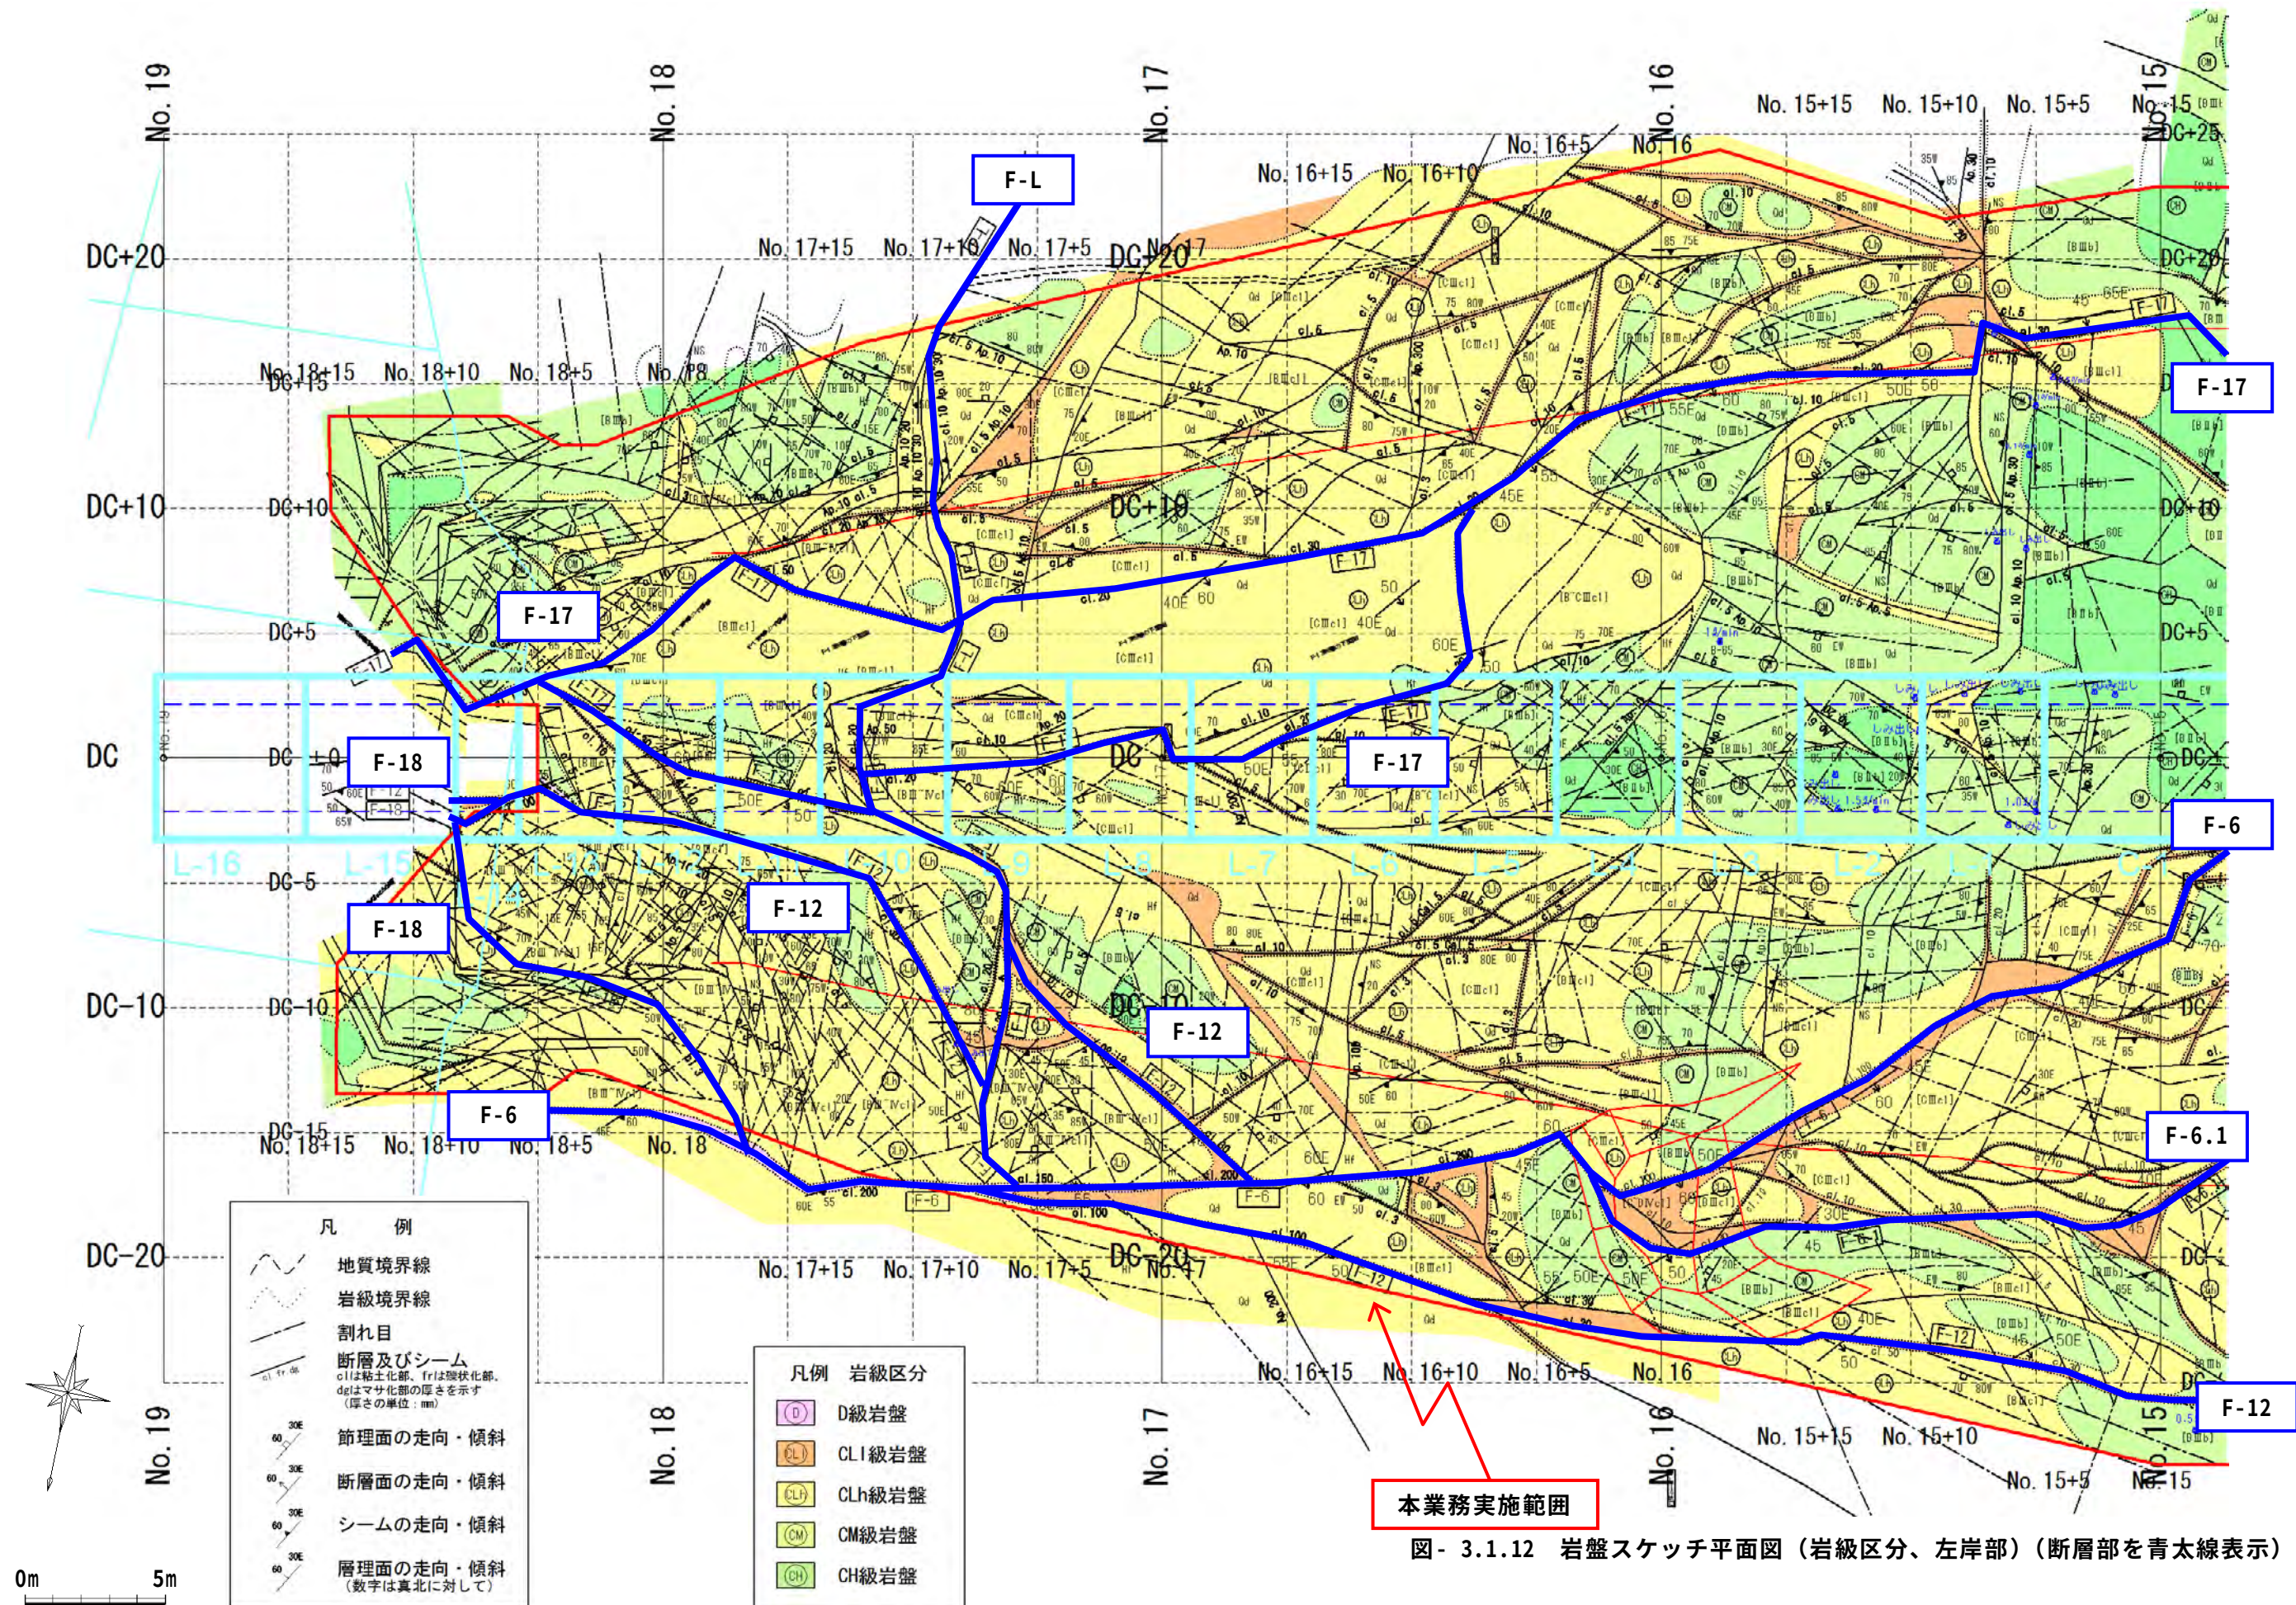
岩盤スケッチ平面図 (岩級区分、左岸部) (断層部を青太線表示)
